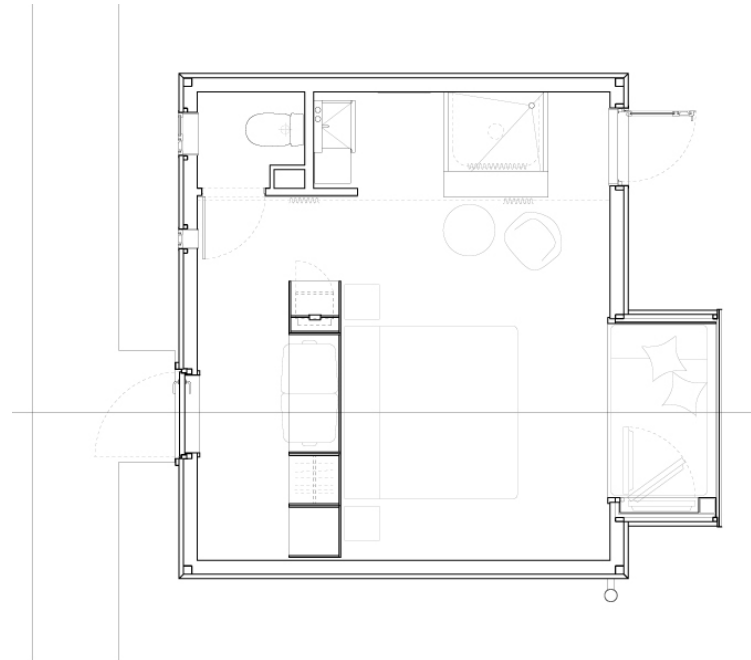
Planta Habitación Hotel Aire de Bardenas, España.
